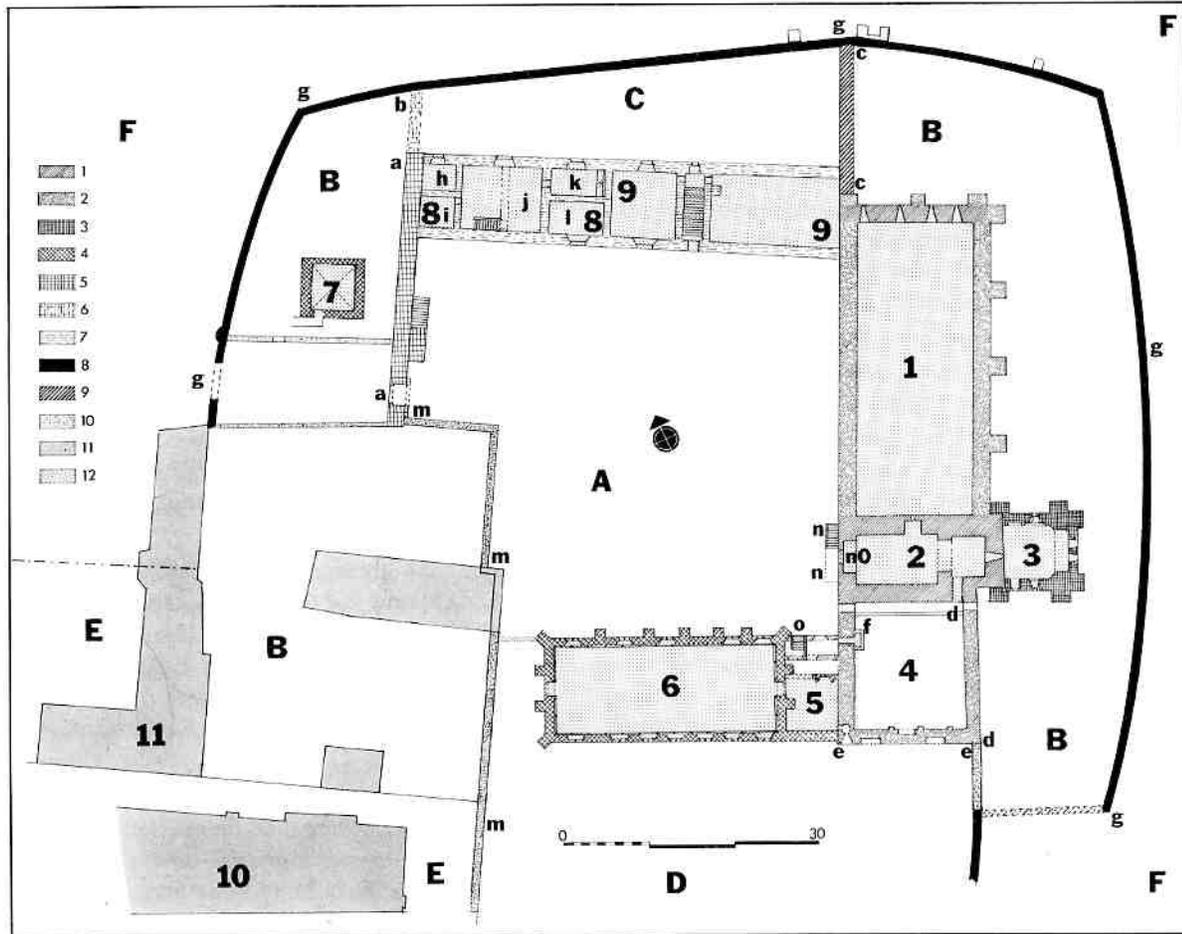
PLAN RESTITUÉ DU PALAIS AU REZ-DE-CHAUSSÉE, AVEC CONSOLIDATION DES PLANS DE 1963, DE 1881, LE CADASTRE DE 1844, ET LE PLAN DES ORATORIENS DE 1671
